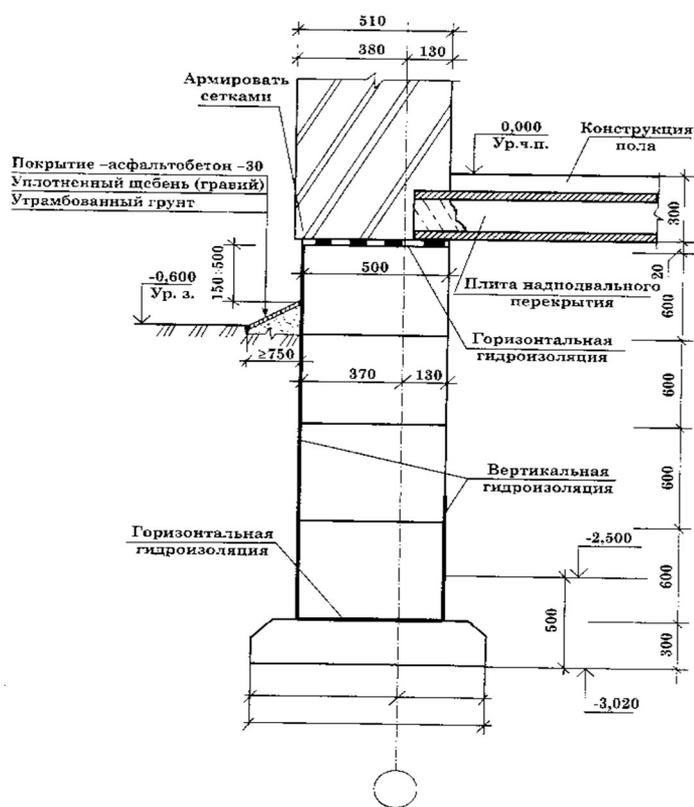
Устройство гидроизоляции в здании с подвалом
